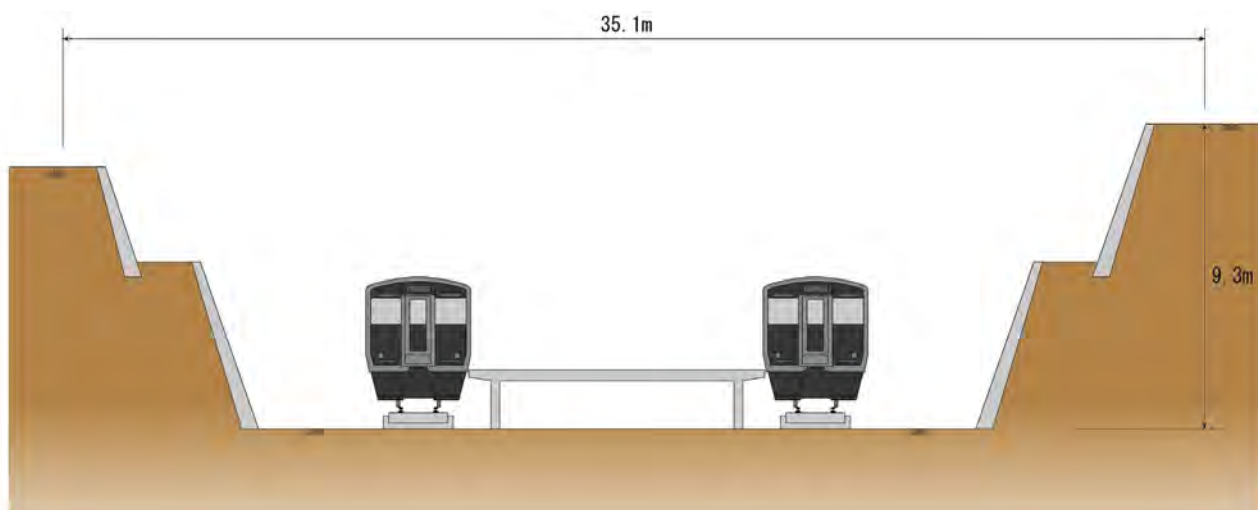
(5) 計画路線の標準横断面図 (断面⑤：地表式)
